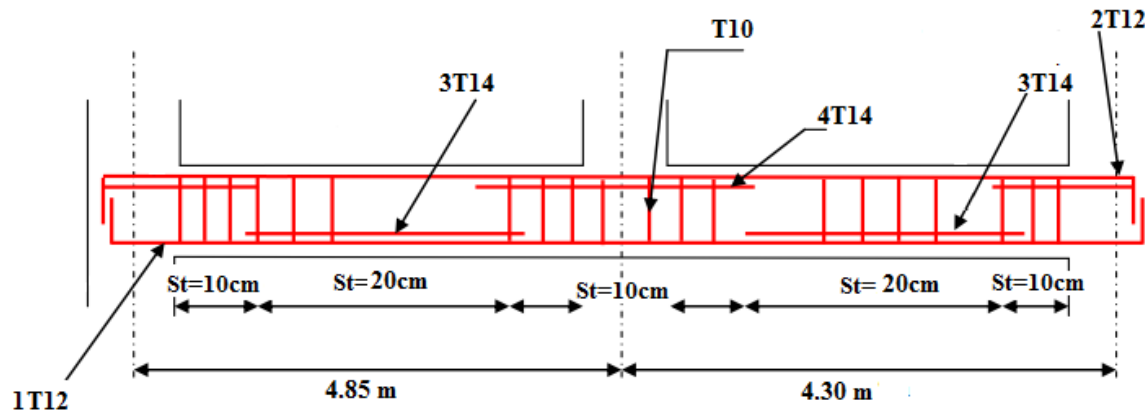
Schéma explicatif du ferrailage des poutres principales
